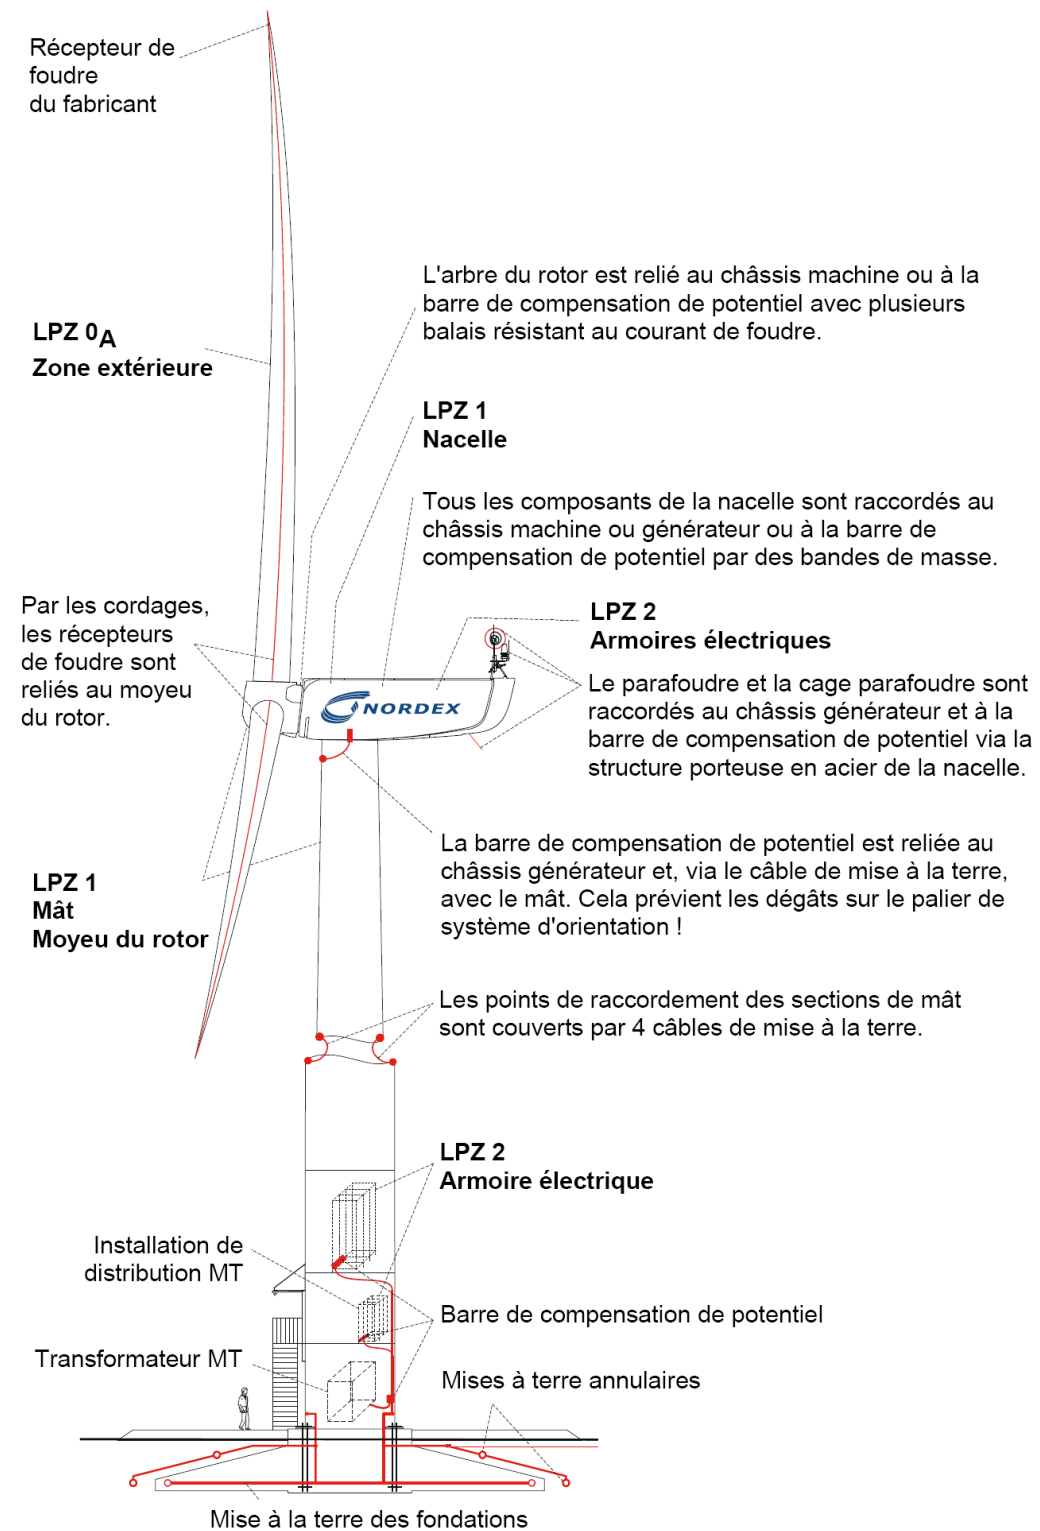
Dessin de vue d'ensemble des dispositifs de protection parafoudre dans l'éolienne (source : NORDEX)
